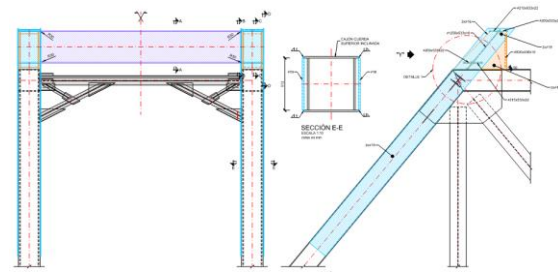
Detalle del refuerzo del marco extremo de la cercha
